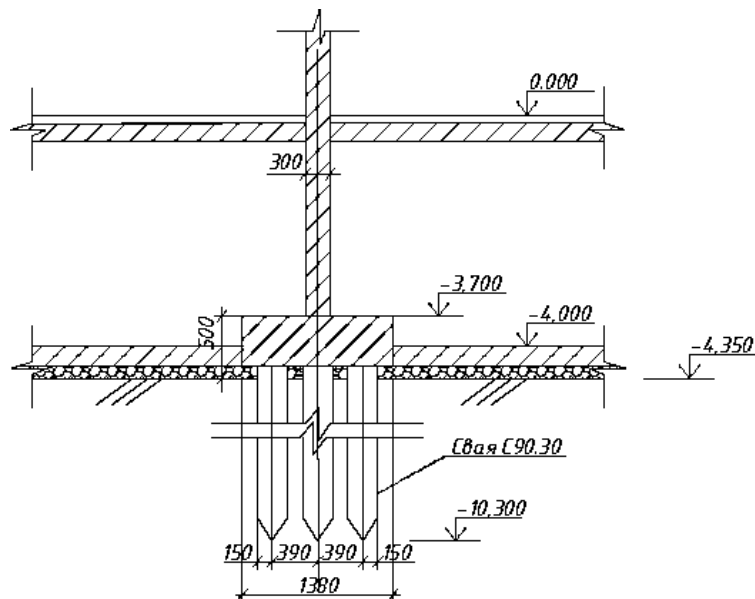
Схематичный разрез фундамента под внутреннюю стену
